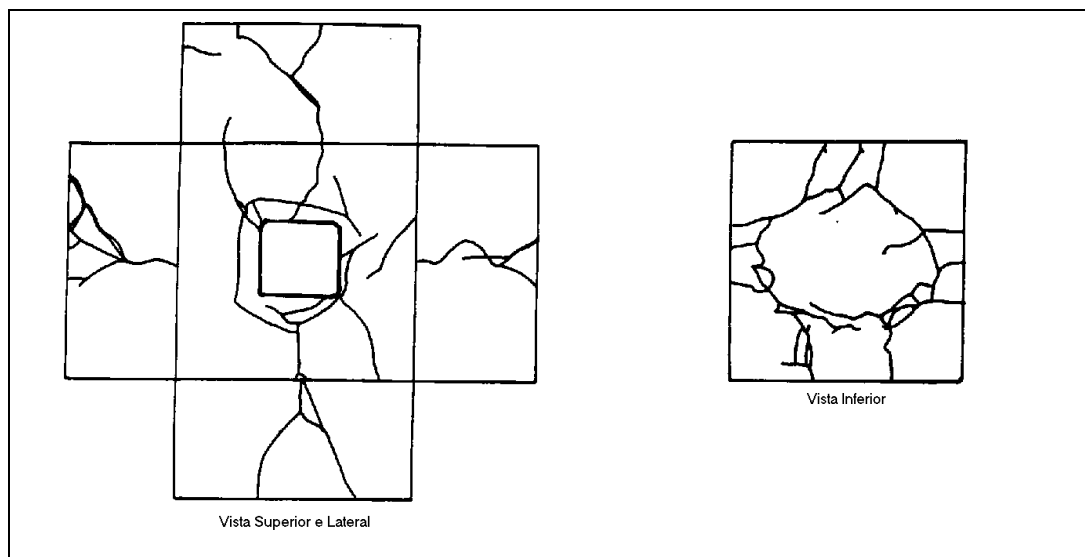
Panorama de fissuração experimental obtido por Sam; Iyer (1995) para bloco rígido de fundação com armadura em malha
